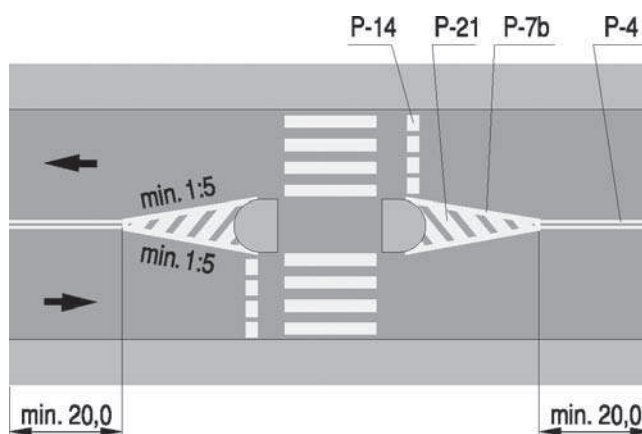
Sposób wyznaczenia poszerzonego przejścia dla pieszych przy przystanku tramwajowym
